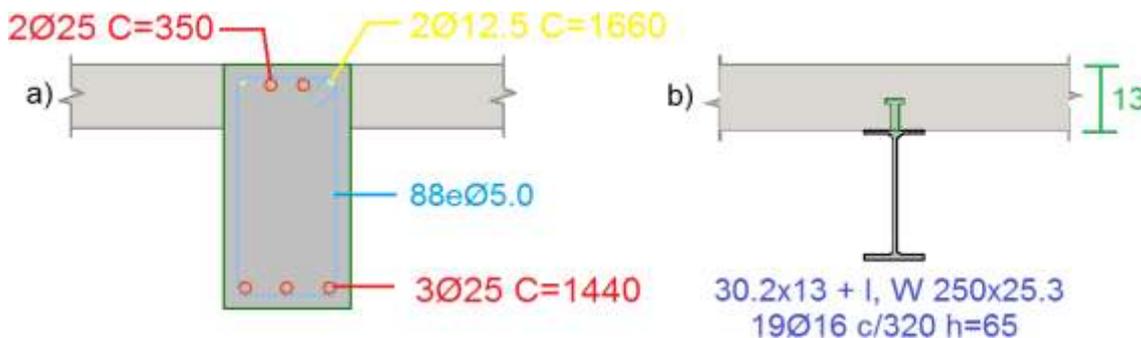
Detalhamento das vigas da Opção 02 em corte transversal.
